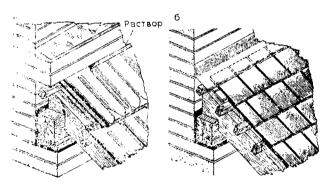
Примыкание кровли к стенам a-c устройством выступа; b-c фартуком
